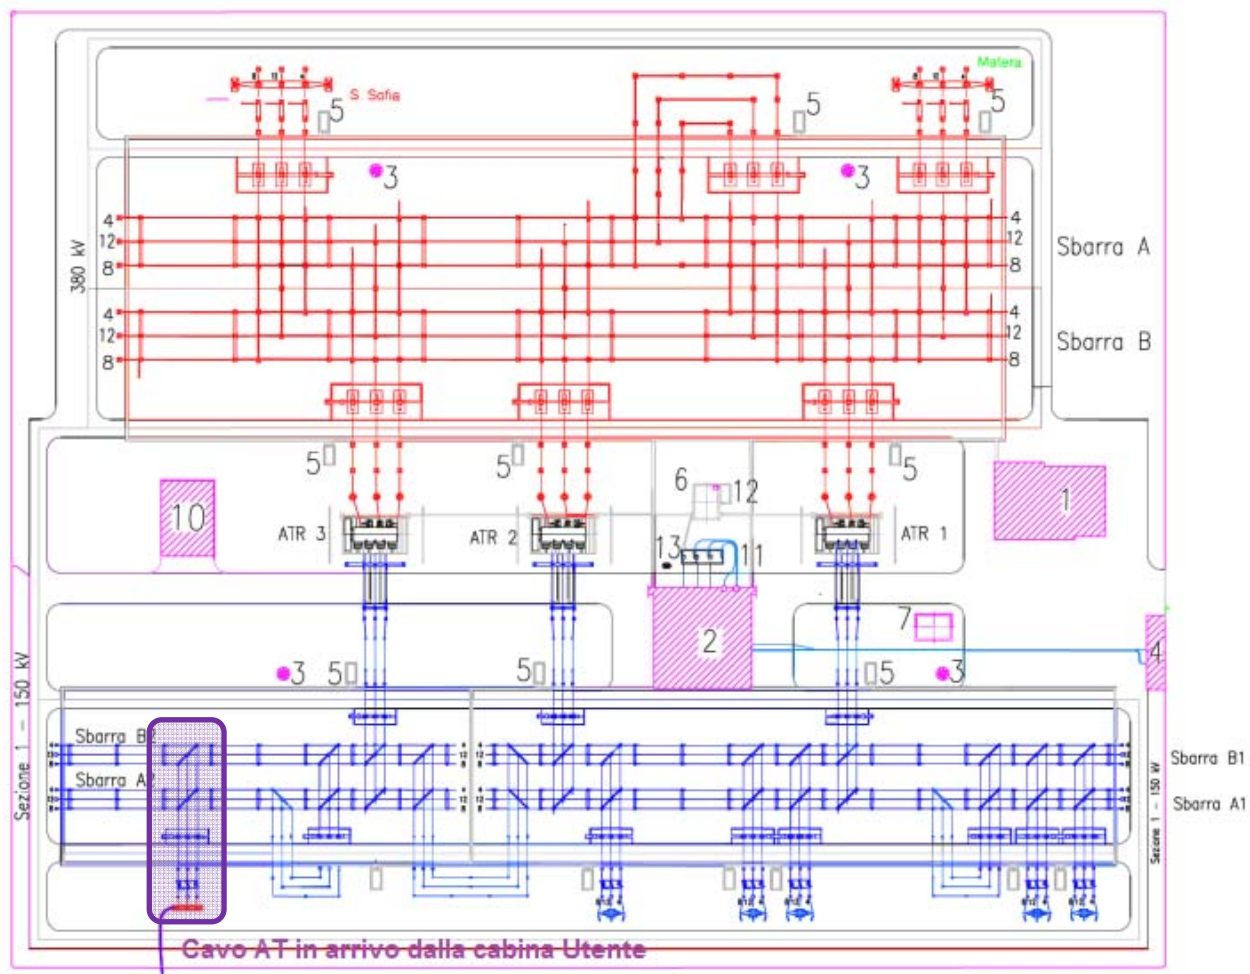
Planimetria Stazione Terna di Genzano e stallo dedicato a RC Wind (in viola)
